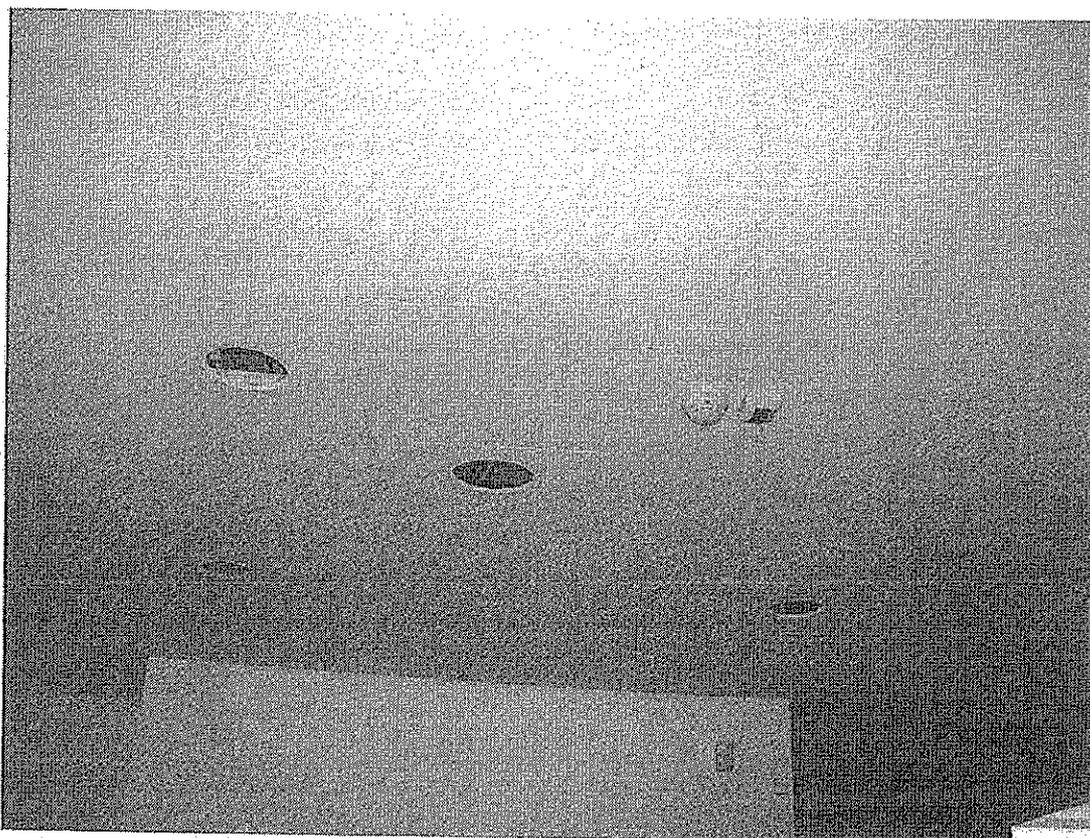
Stato di fatto dei punti luce nel negozio ex [REDACTED]
